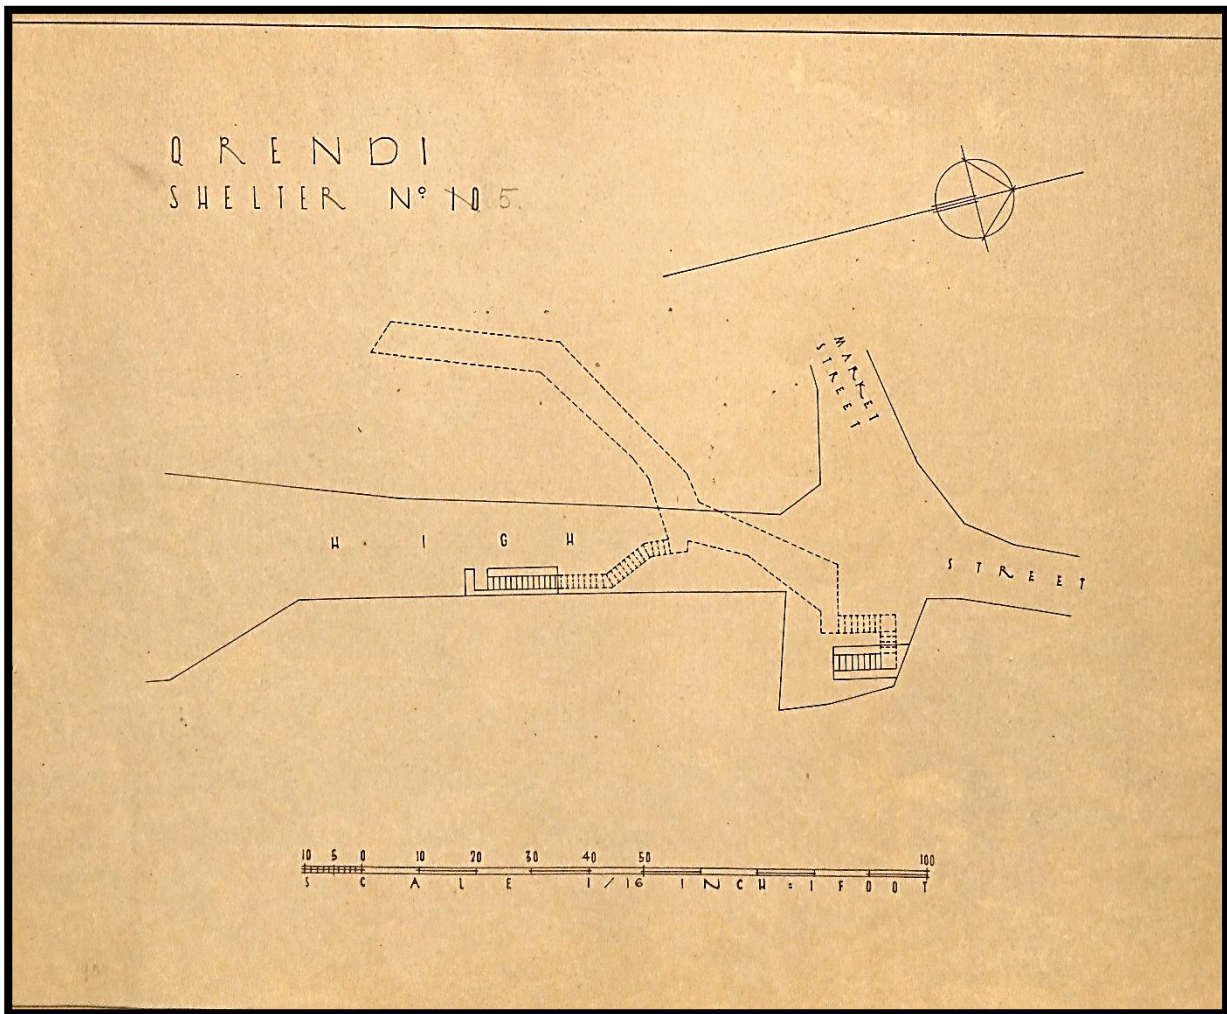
Planta do Abrigo nº5 "High Street – Market Street."
